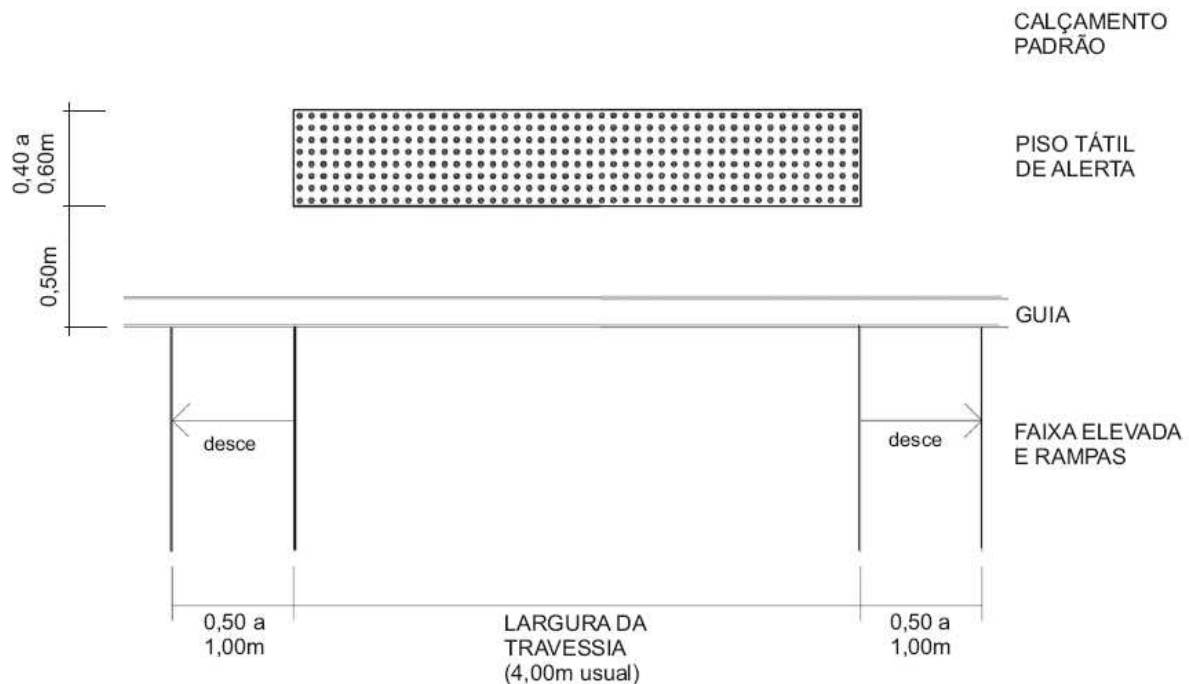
Aplicação de piso tátil de alerta em faixa elevada.
